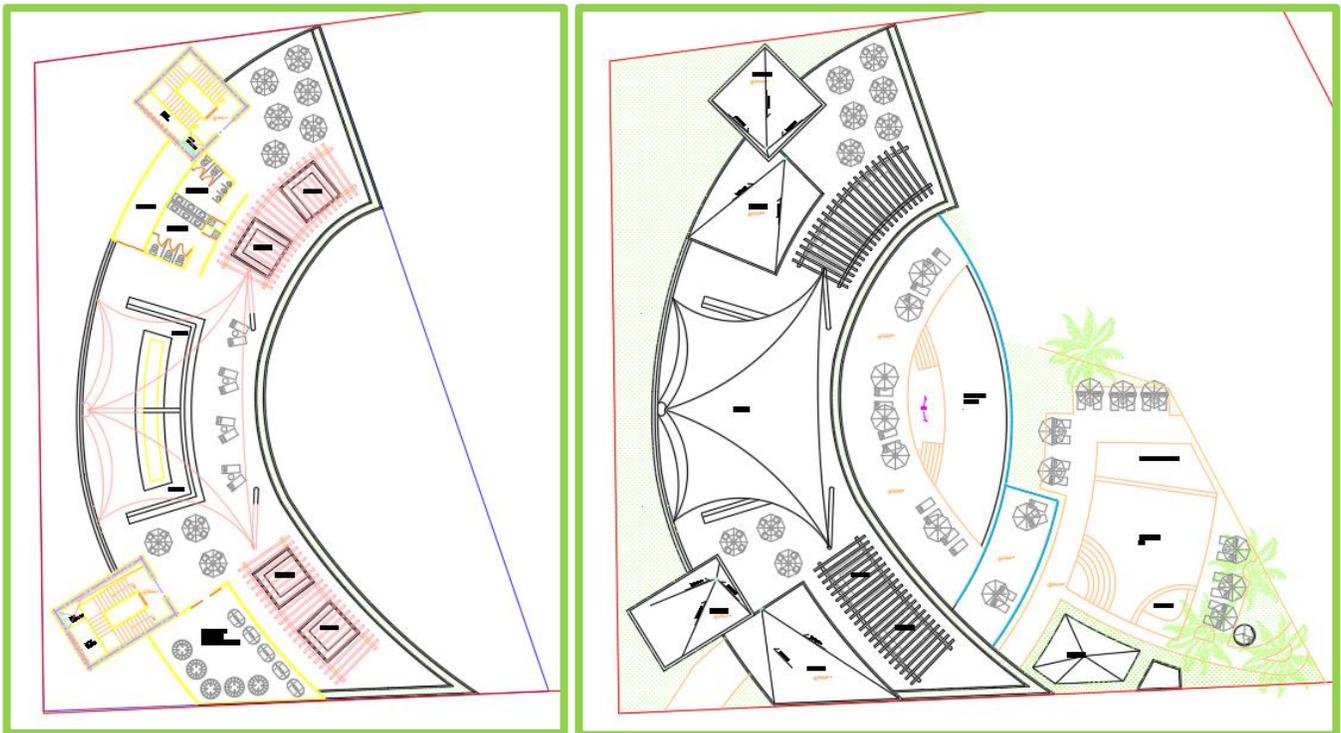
Detalle del diagrama del polígono del Sótano y Planta baja
